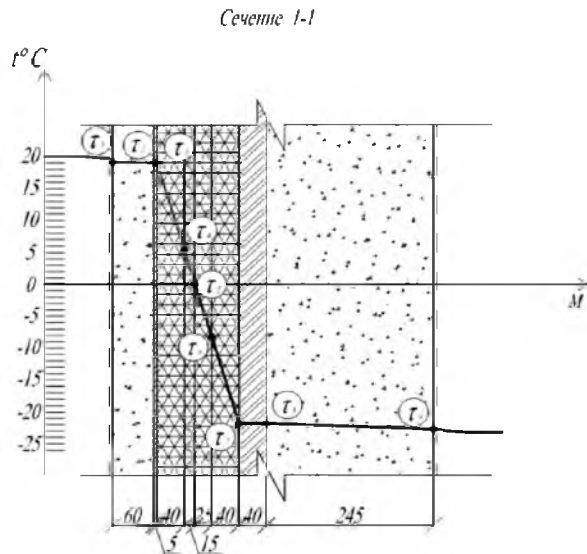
Распределение температур в зоне конструктивного узла «балконная плита – ограждающая конструкция – плита перекрытия» по сечению 1-1/
